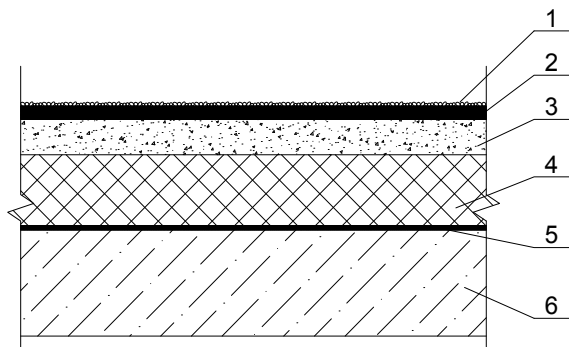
Конструкция совмещенной кровли, в которой все слои последовательно уложены на несущую конструкцию и покрыты водоизоляционным ковром:
